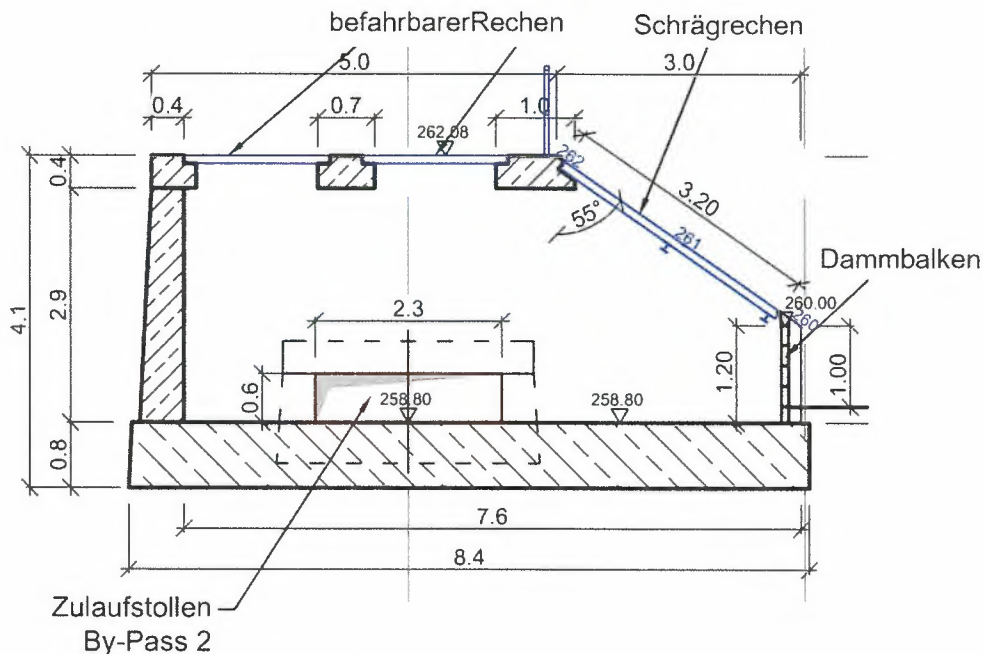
Schnitt durch das Einlaufbauwerk des Bypasses 2 (aus Beilage 12.5.7)
